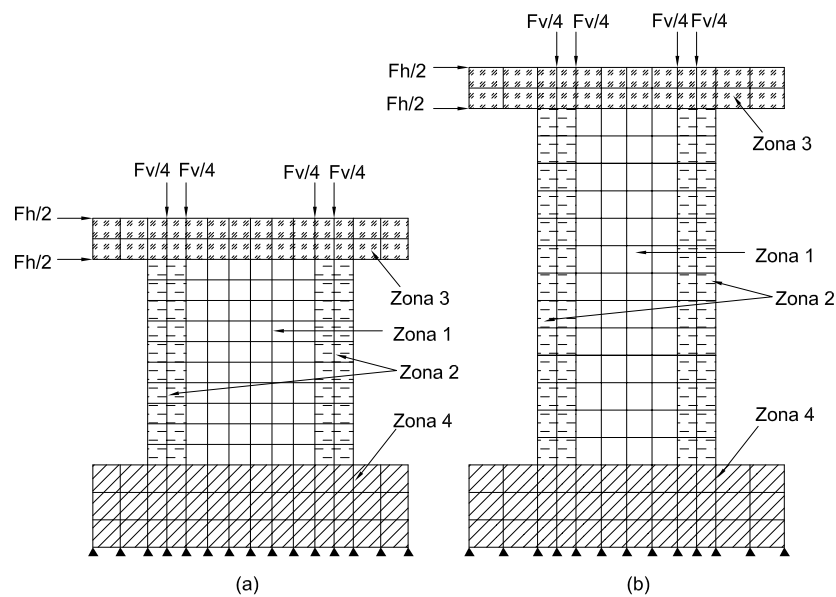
Geometria e detalhes das armaduras das paredes de concreto armado, Lefas et al. (1990)
